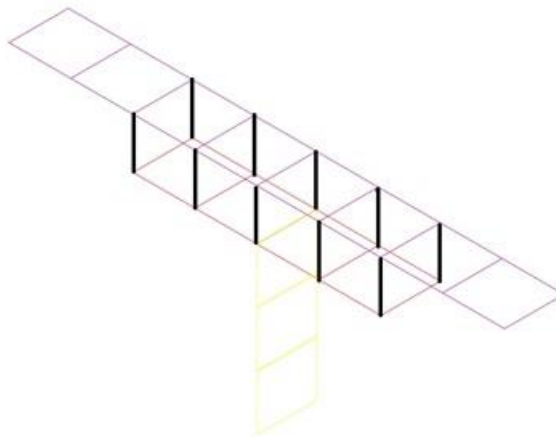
Ligação laje e viga ao longo do vão. Legenda de cores: alma – elemento amarelo; mesa – elemento vermelho; link – linha preta; laje – elemento roxo.
